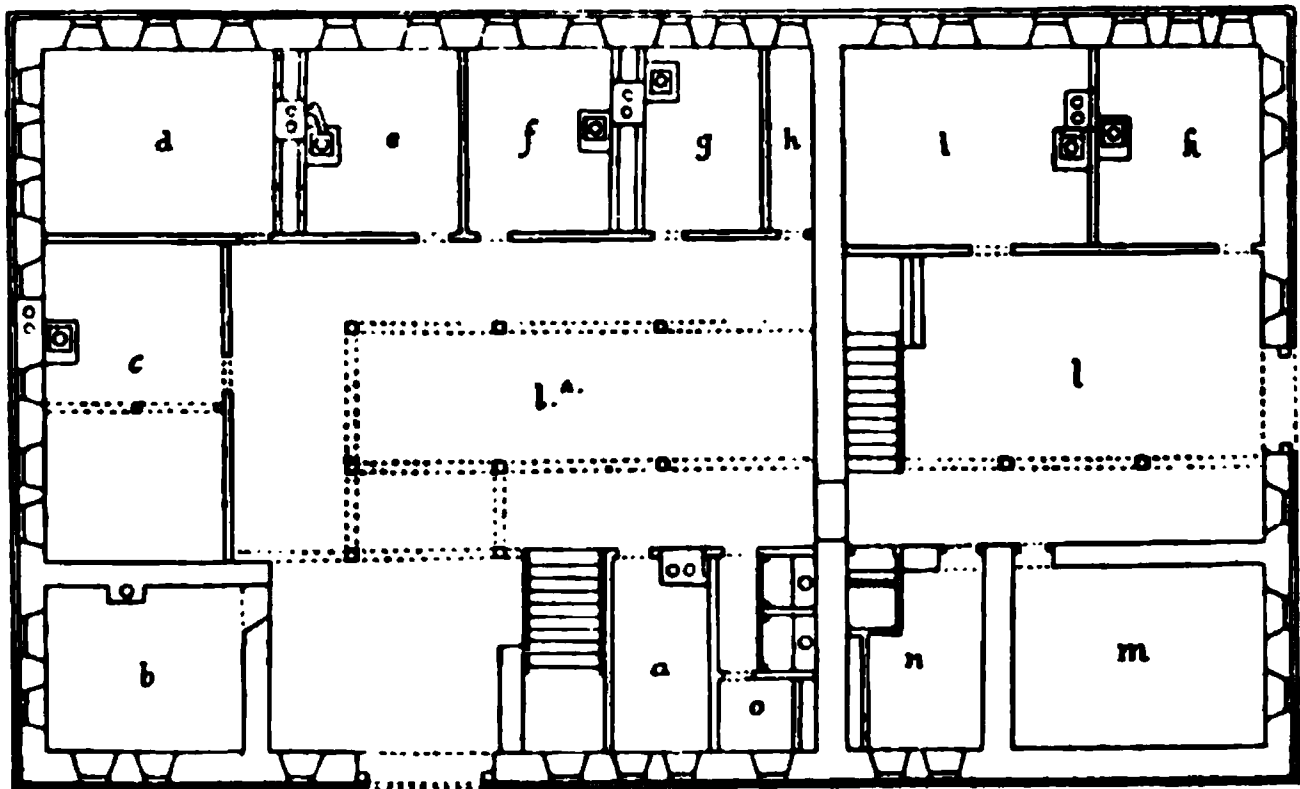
a. Grosser Konak zu Travnik. Grundriss Parterre.
